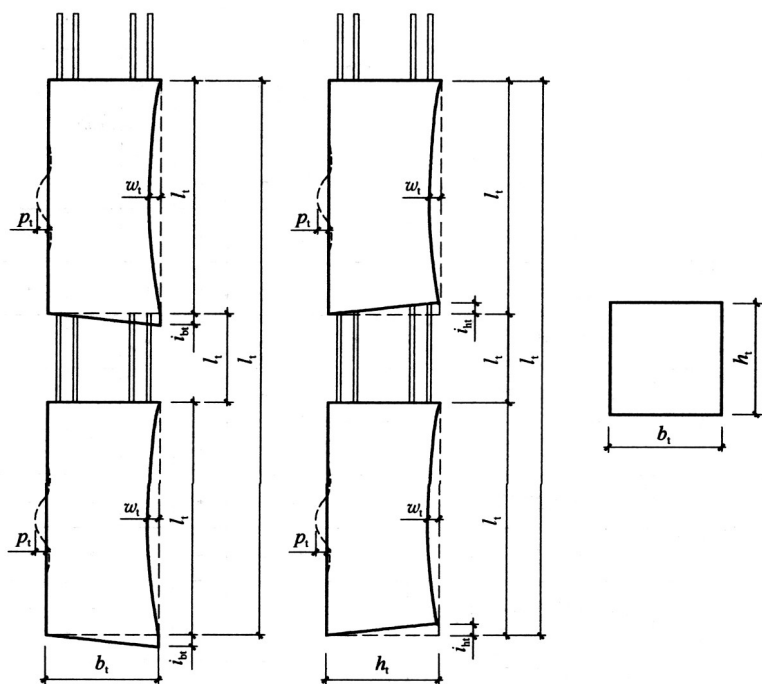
多层节段预制柱尺寸偏差示意
